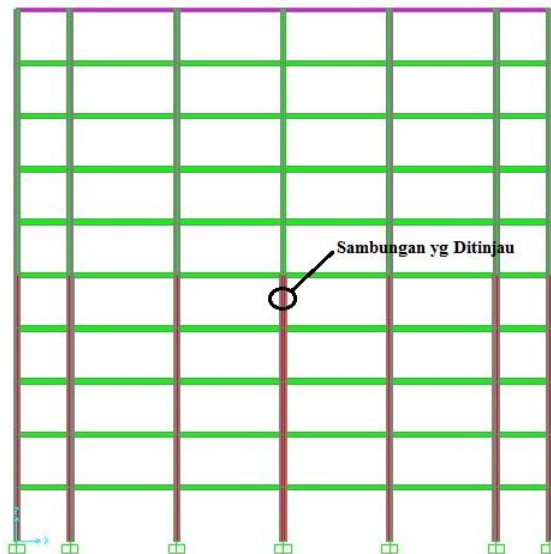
Detail sambungan kolom KC 500.300.11.18
